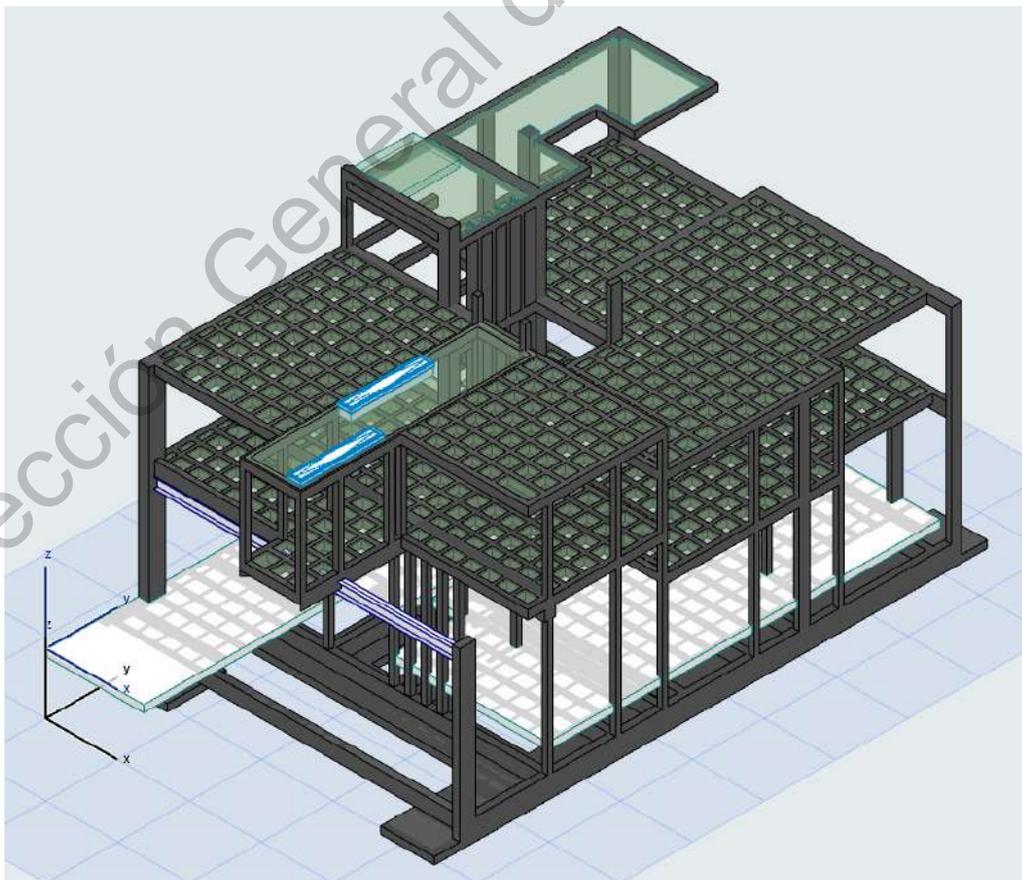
Losas de Concreto de Segundo Nivel y Planta de azoteas de Proyecto 003.
